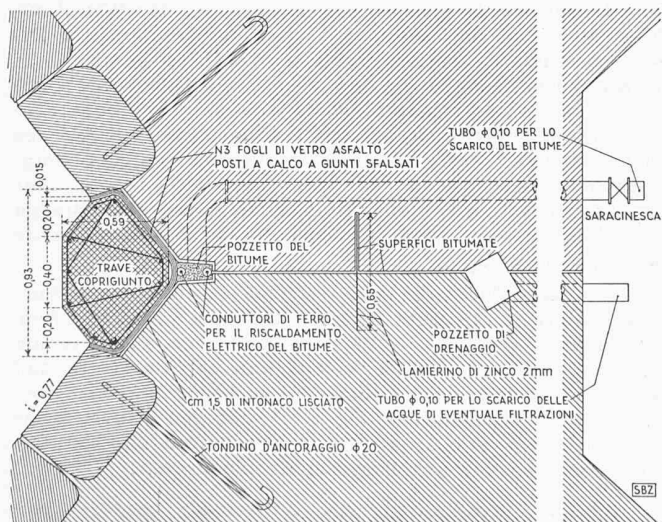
Staumauer Pantano d'Avio. Fugenabdichtung 1:40
